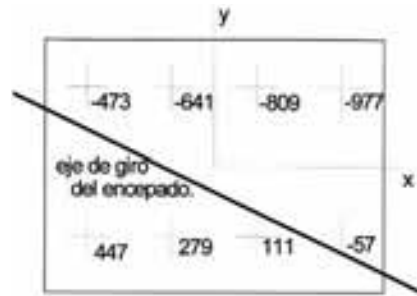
Distribución de cargas por pilote, con reparto rígido.
